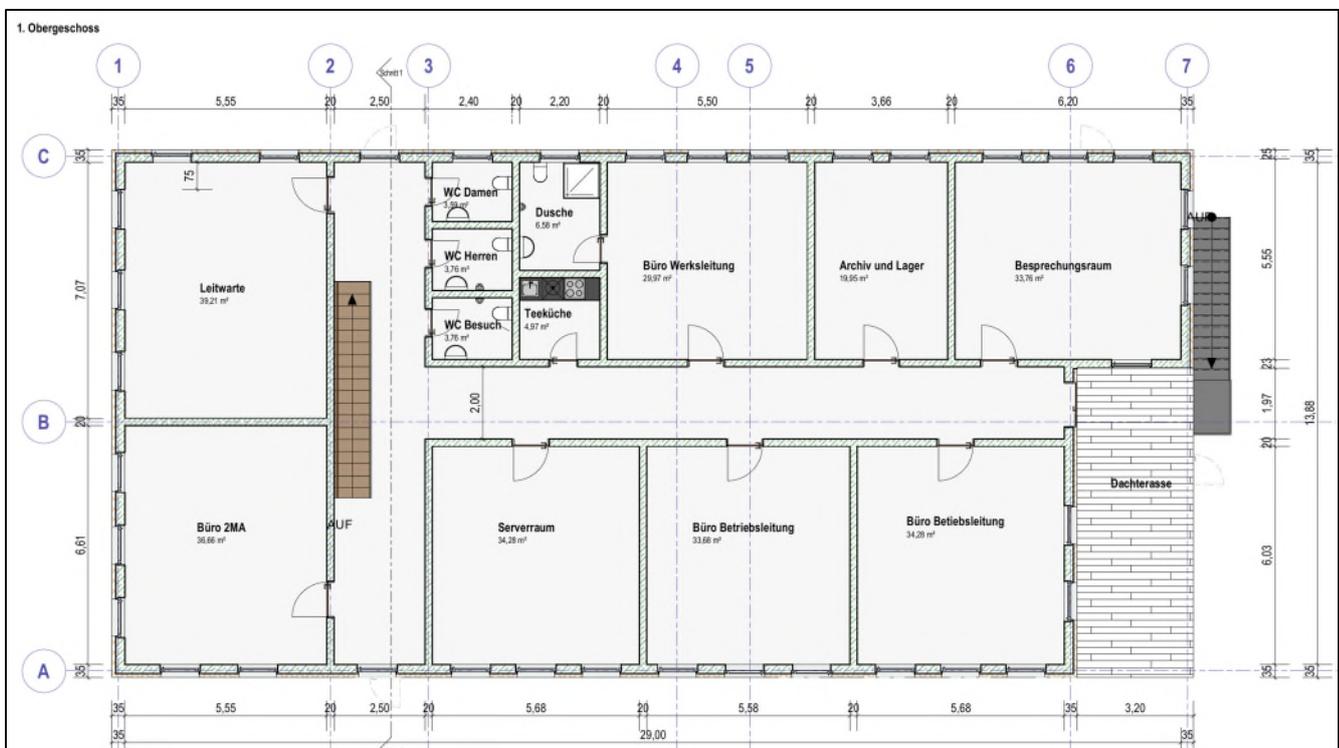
Obergeschoss des BEZ-Betriebsgebäudes
